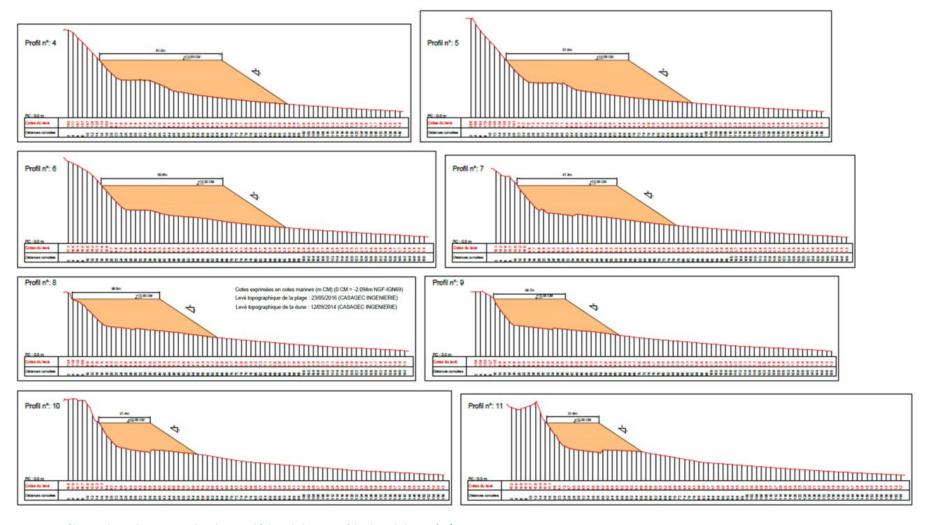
Profils type des rechargements des plages Sud (plage de la Savane à la plage de la Piste) 1/2.
